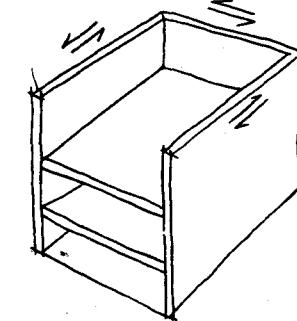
Решение 4. Открытый фасад, фактор кручения учтен в расчете
